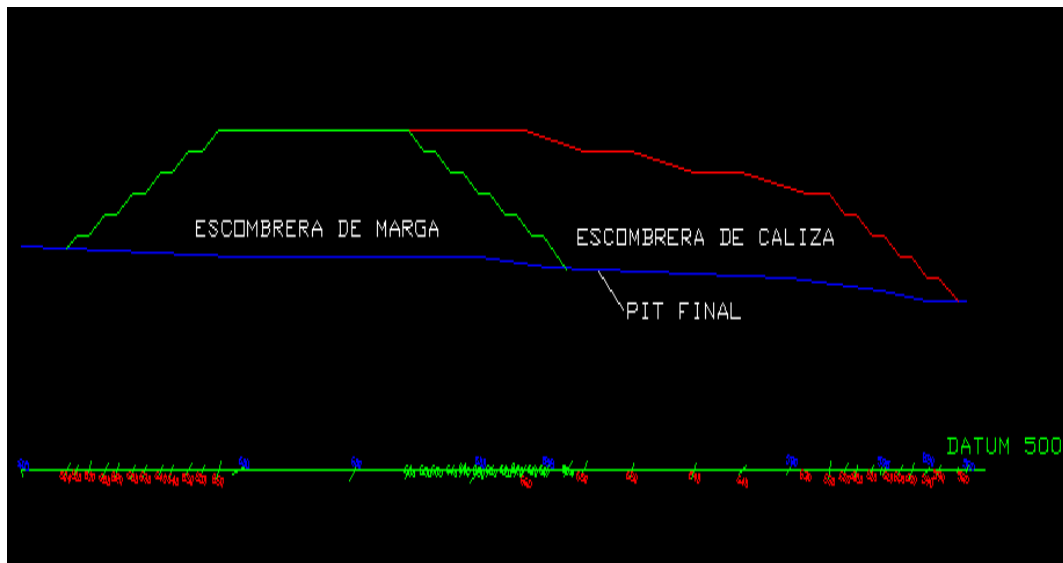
Perfil longitudinal de las escombreras al final de la construcción
